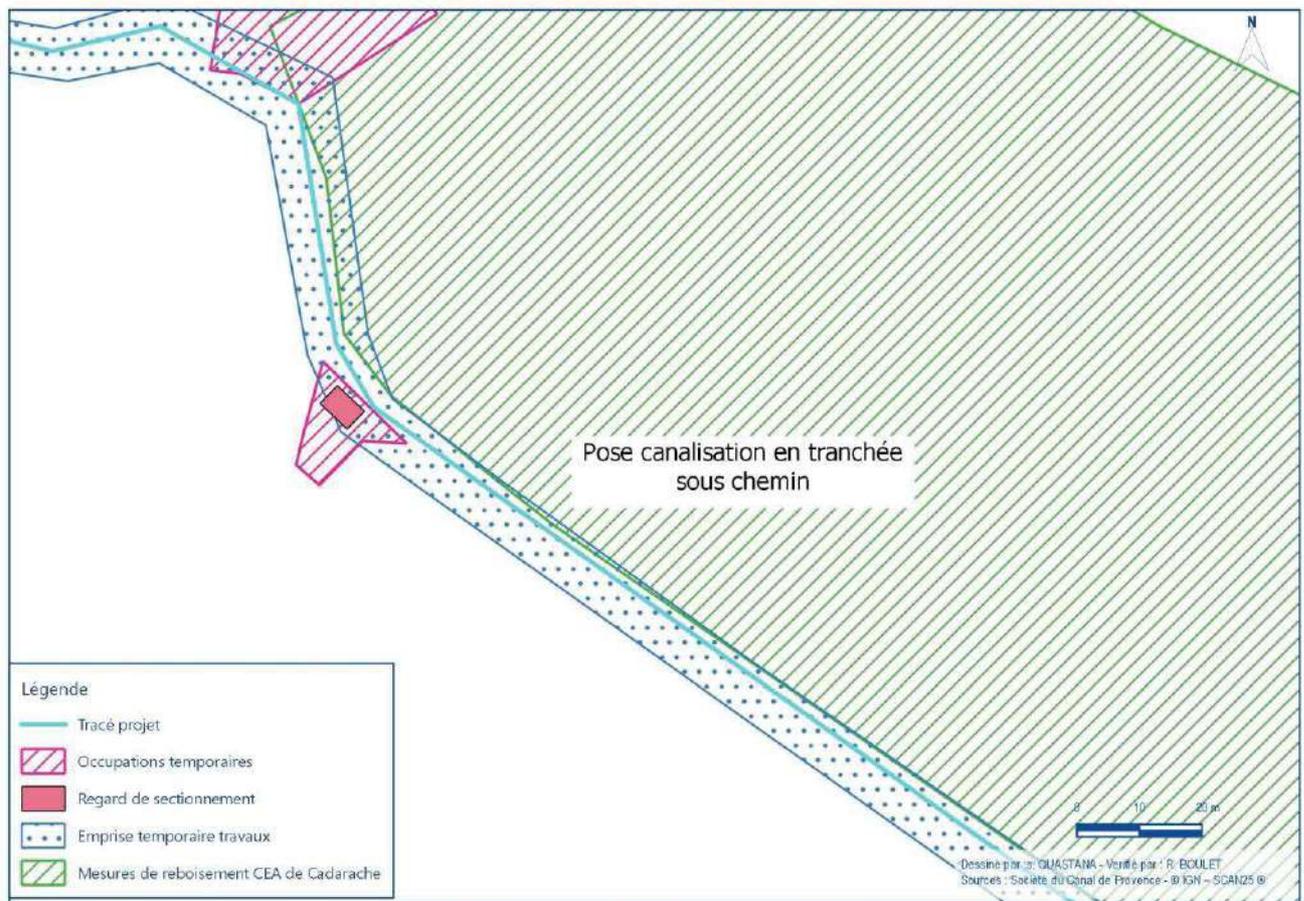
Zoom sur le secteur d'emplacement du regard de sectionnement
